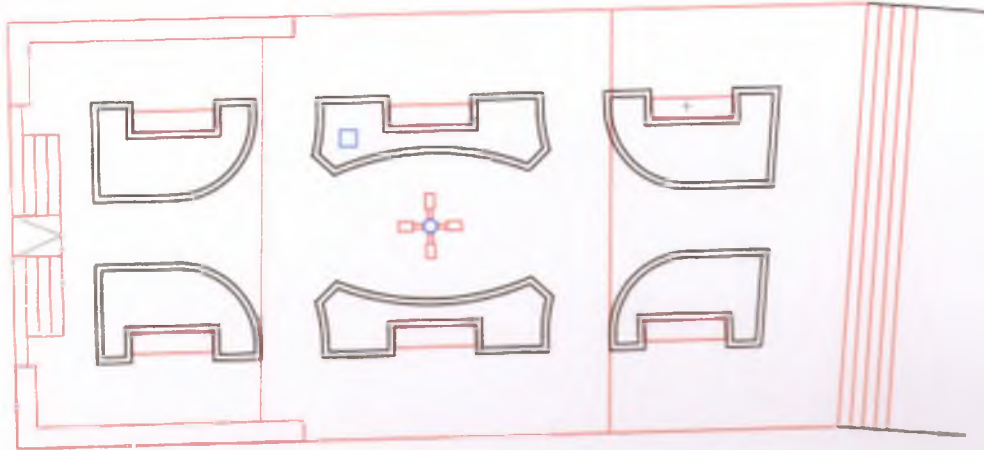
Planta baixa da praça do Baixio das Palmeiras.
